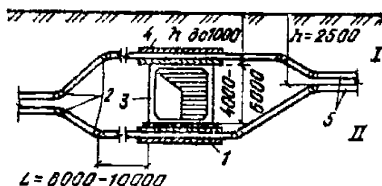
Узел пересечения трубопровода с тоннелем:
